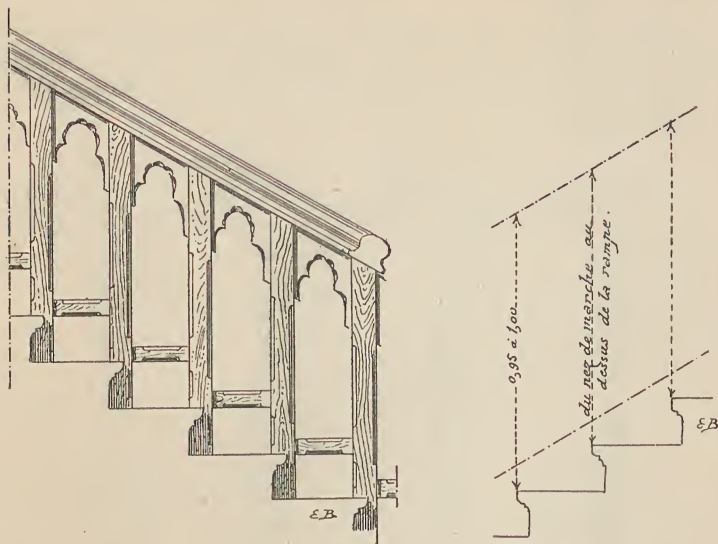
Balustrade sur marches. Fig. 634. — Hauteur de rampe.
